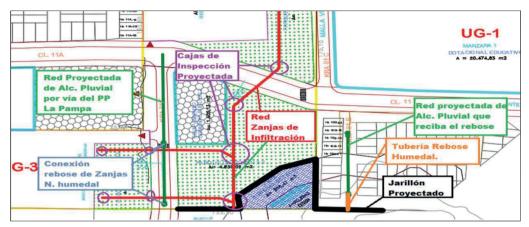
Esquema del jarillón y tubería de rebose que entregaría al redes proyectadas de Alc. Pluvial que posteriormente entregaría a redes existentes a la altura de la calle 11 con cra 81B.
